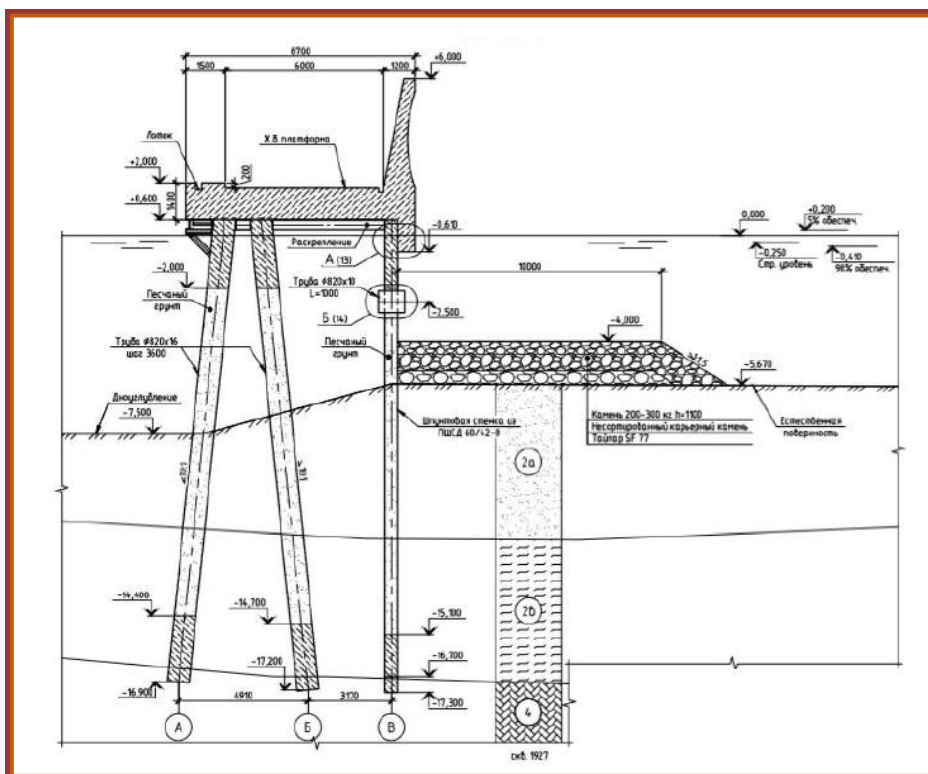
Конструкция основной части Южного мола с дополнительными отверстиями
